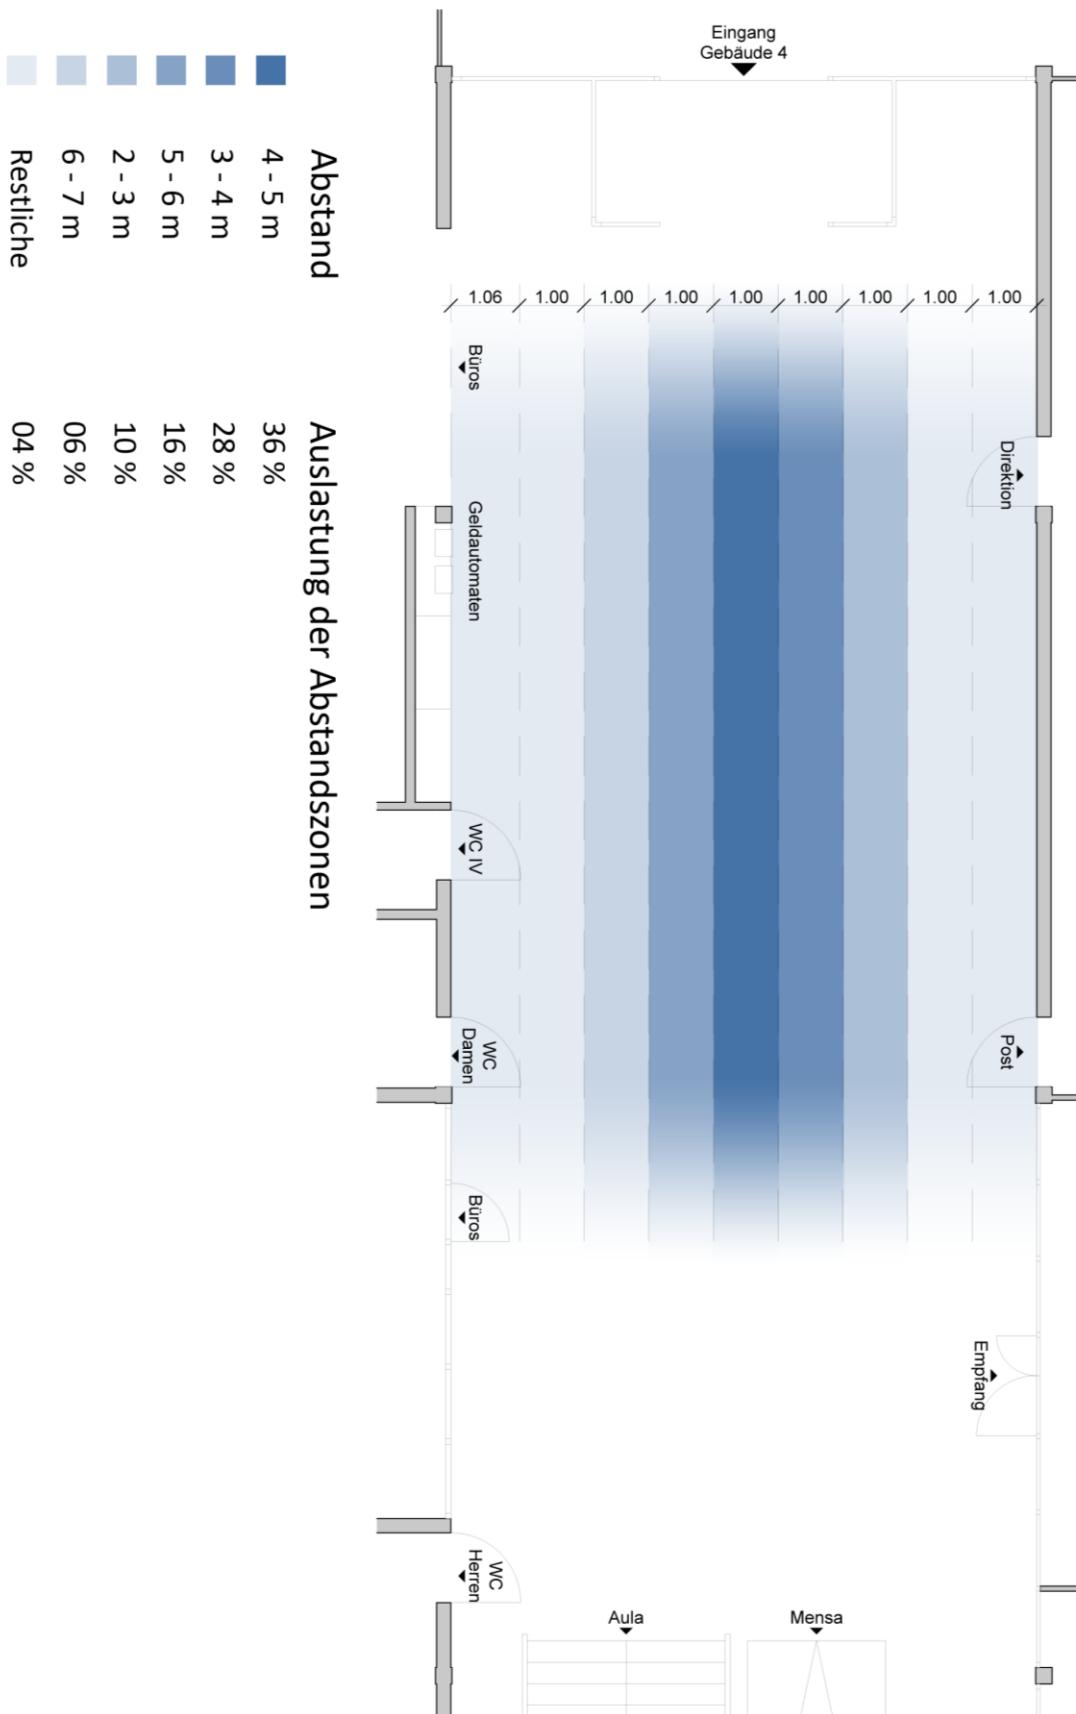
Auslastung der Abstandszonen, Grundriss Verwaltungsgebäude
